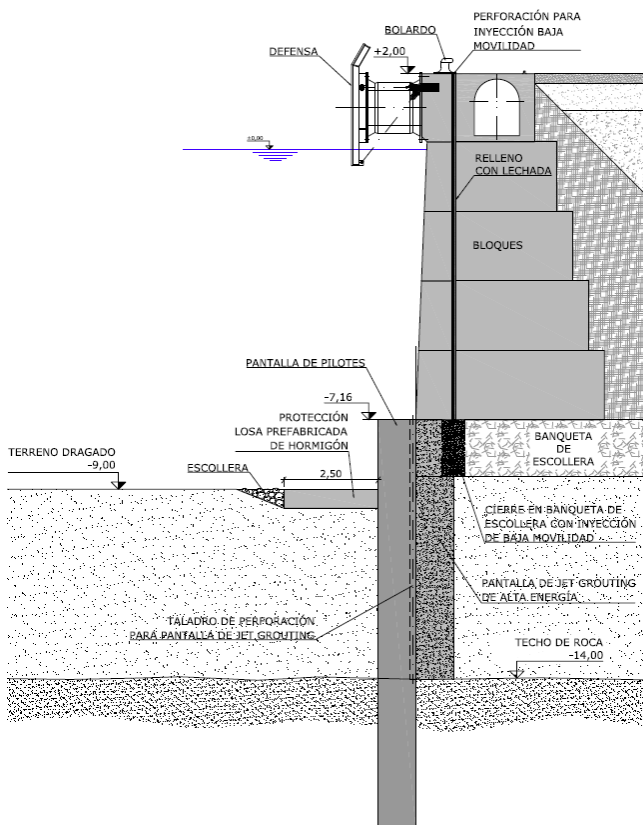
Esquema de disposición de pilotes, columnas de jet-grouting y cierre con mortero de baja movilidad en muelle de bloques
